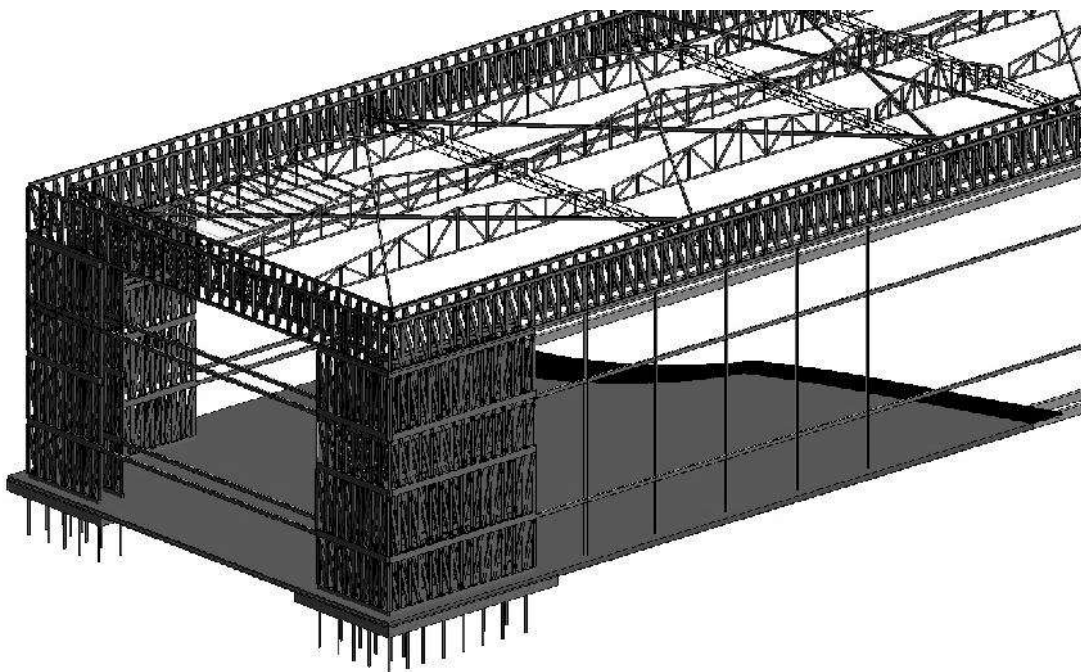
Estructura de los muros dobles estructurales y del detalle de los pilotes que los sostienen.
